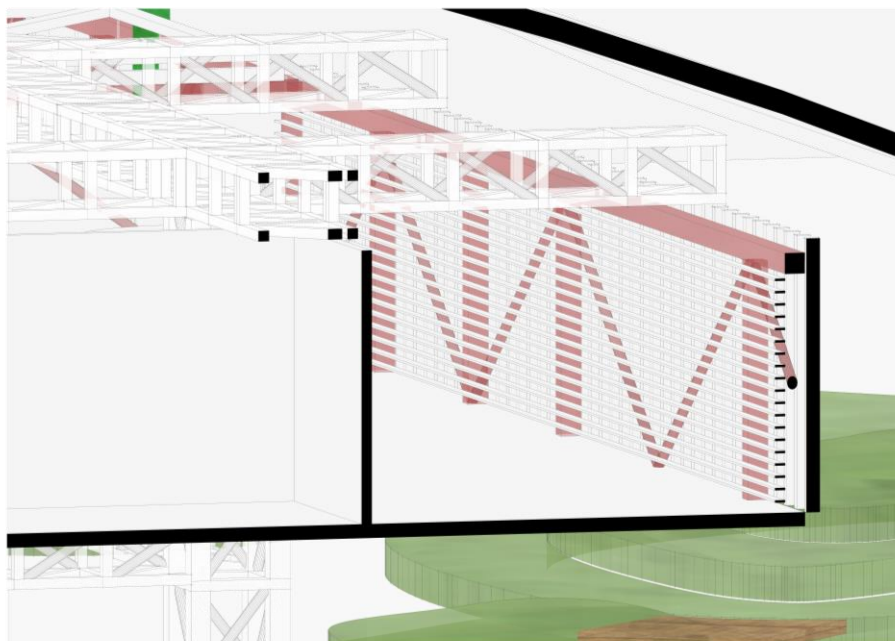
Tectónica del material: Estructura. Fuente: Elaboración Propia
